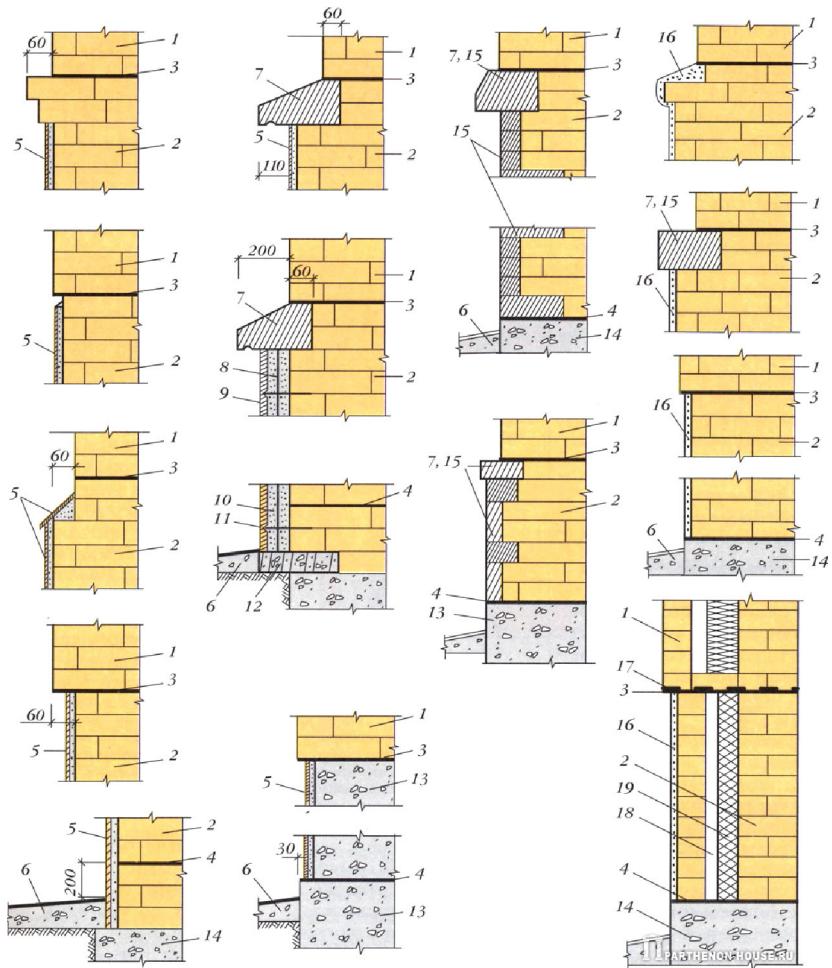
Конструктивные решения цоколя из кирпича: 1 – конструкция стены; 2 – цоколь из кирпича; 3 – гидроизоляция из двух слоев толя или рубероида; 4 – гидроизоляция по фундаменту или в теле цоколя; 5 – керамическая плитка на цементно-песчаном растворе; 6 – отмостка; 7 – облицовочный фризовый камень; 8 – сетка $150 \times 150 \times 4$ см, привязанная к выпускам арматуры; 9 – облицовочная плитка из естественного камня; 10 – жесткий цементный раствор; 11 – выпуски арматуры, заделанные в кладку; 12 – бетонная подушка; 13 – фундаментные бетонные блоки; 14 – фундамент (из сборных блоков, бутовой кладки, бута и т.д.); 15 – облицовочный кирпич; 16 – штукатурка; 17 – арматурная сетка; 18 – воздушный продух; 19 – утеплитель
